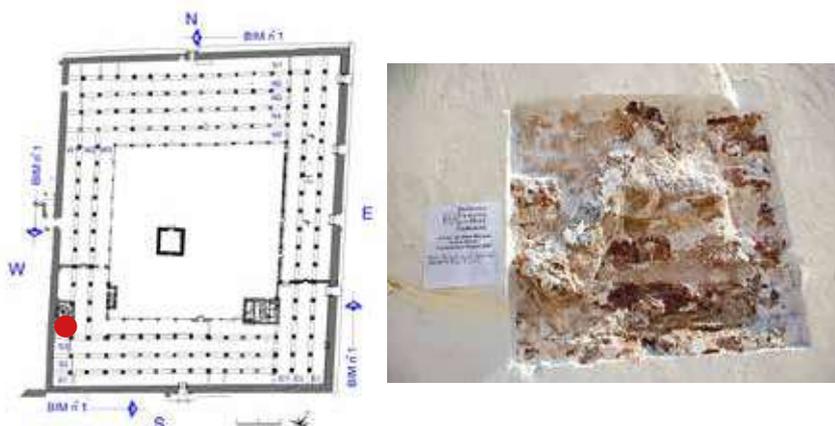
Minareto Ovest, parete Sud, campione nr. MWSW0604
